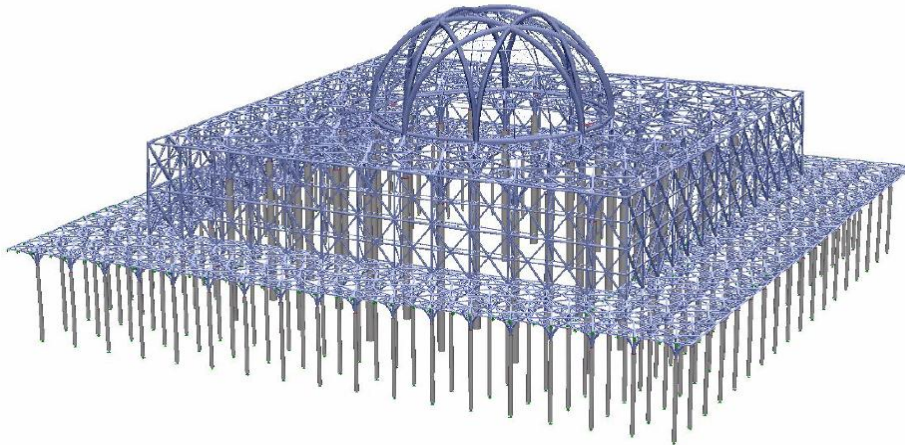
modélisation en 3D de la construction métallique avec les poteaux préfabriqués
